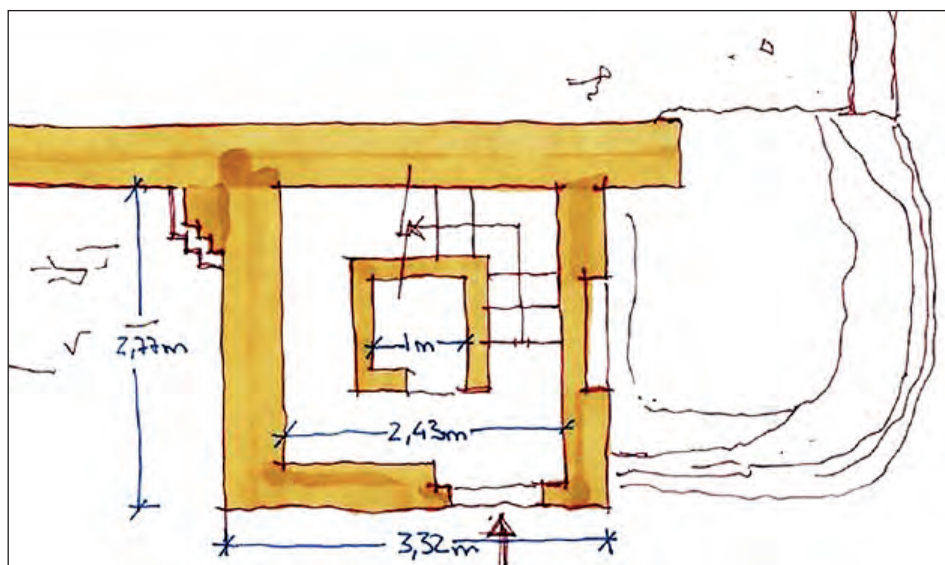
Croquis de la planta de la Torre del Reloj. Javier Borobio Sanchiz.
